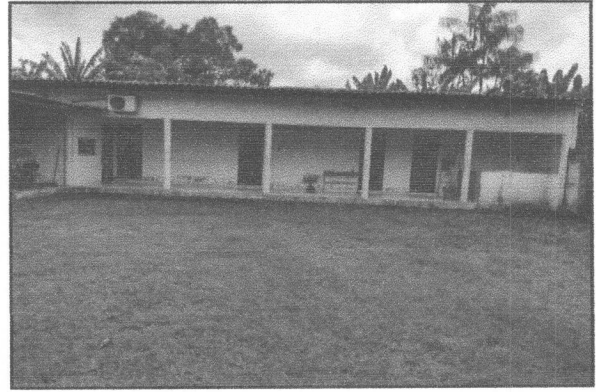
Vista do fachada do prédio anexo ao imóvel, localizado na parte posterior do terreno
